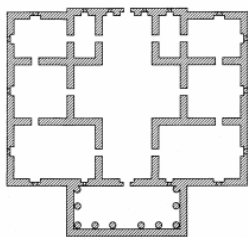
Planta final generada de la Villa Malcontenta.
